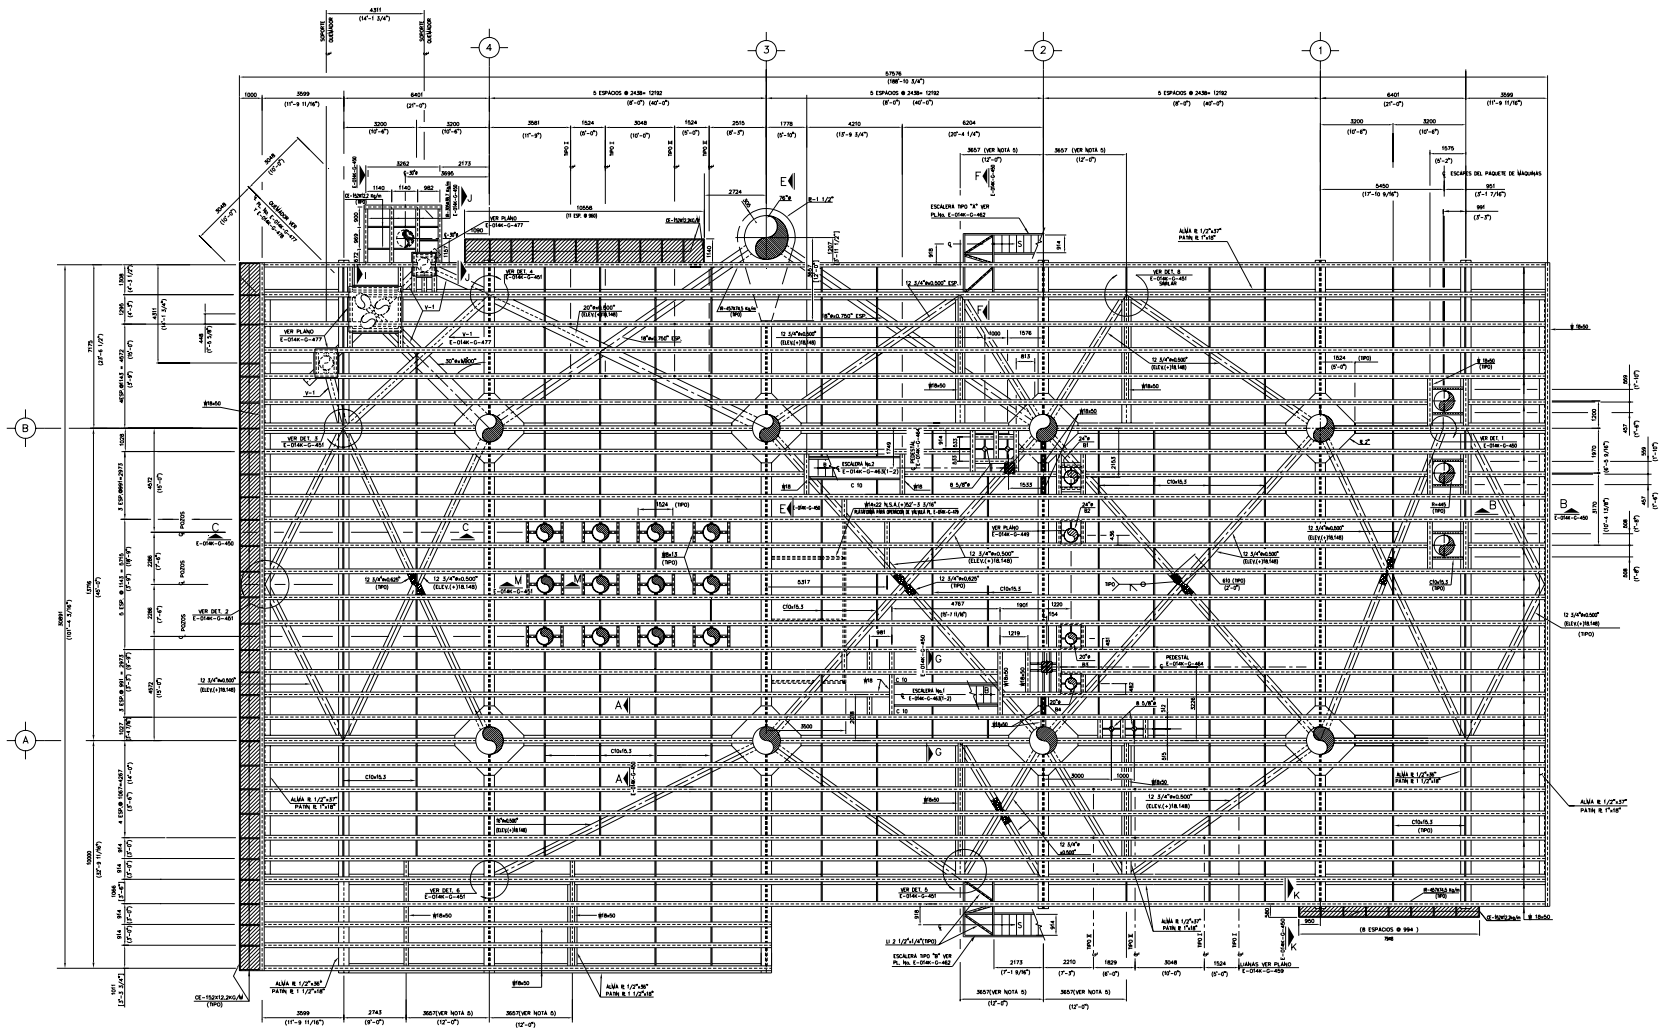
Planta estructural de la cubierta inferior nivel (+) 19.100 (62'-7 15/16").
